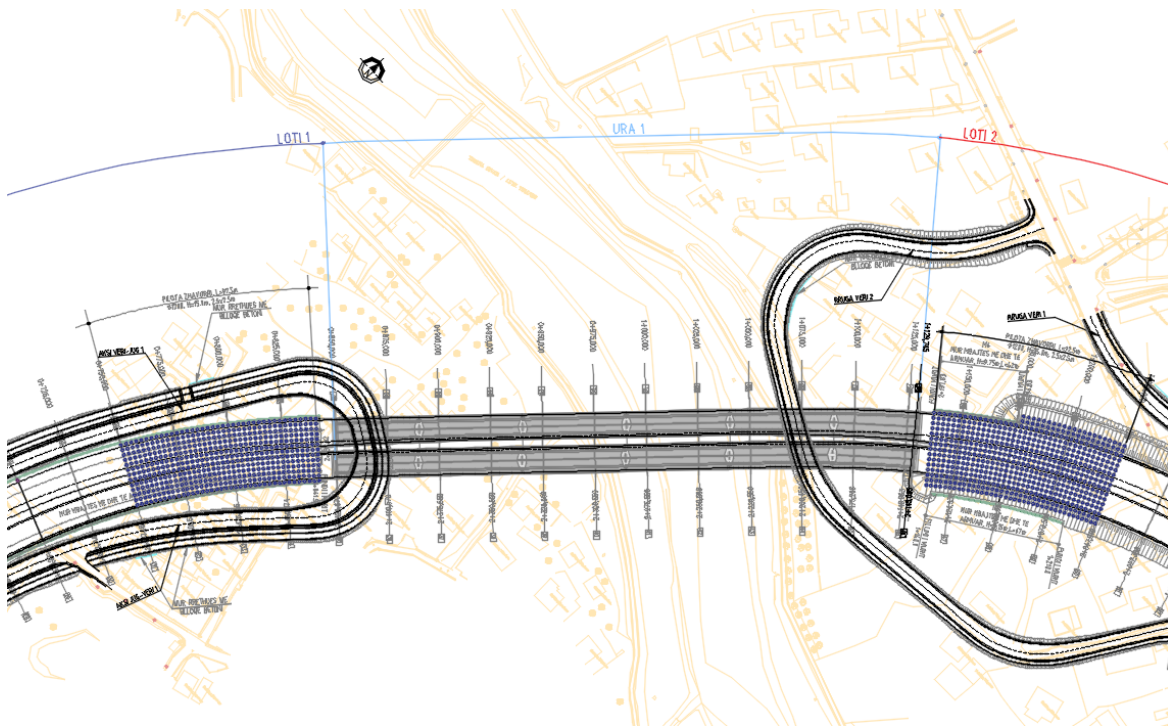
Fragment nga planimetria ku tregohet menyra e vendosjes se pilotave
